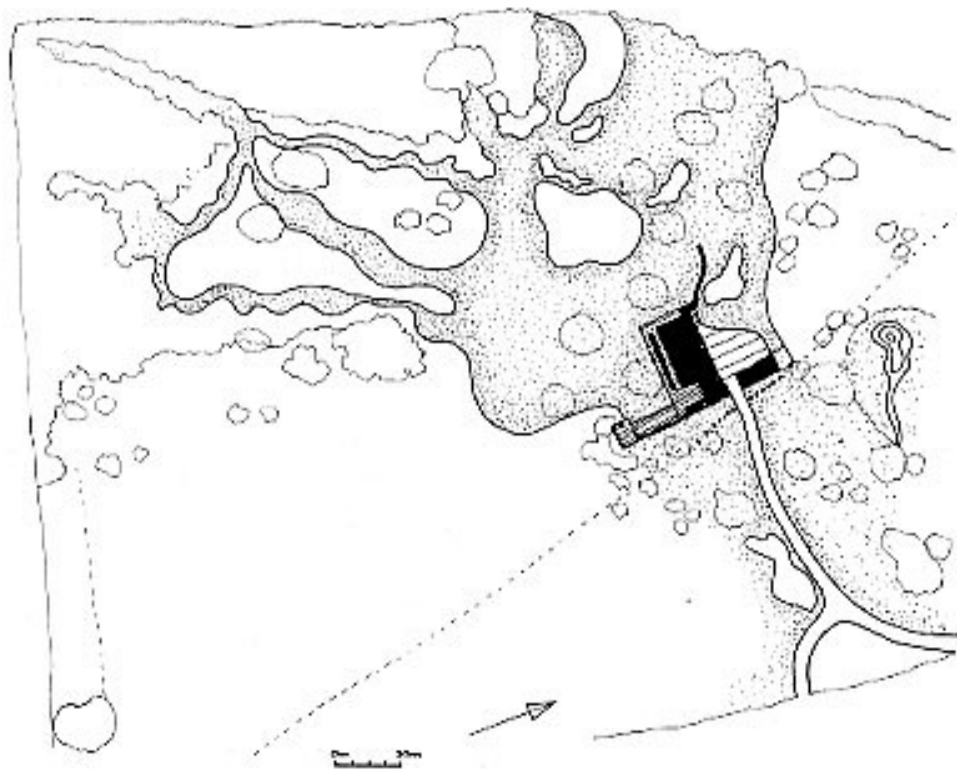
Plano Geral da Bentley Wood House, Tunnard, 1936 | fonte: gardenvisit.com
